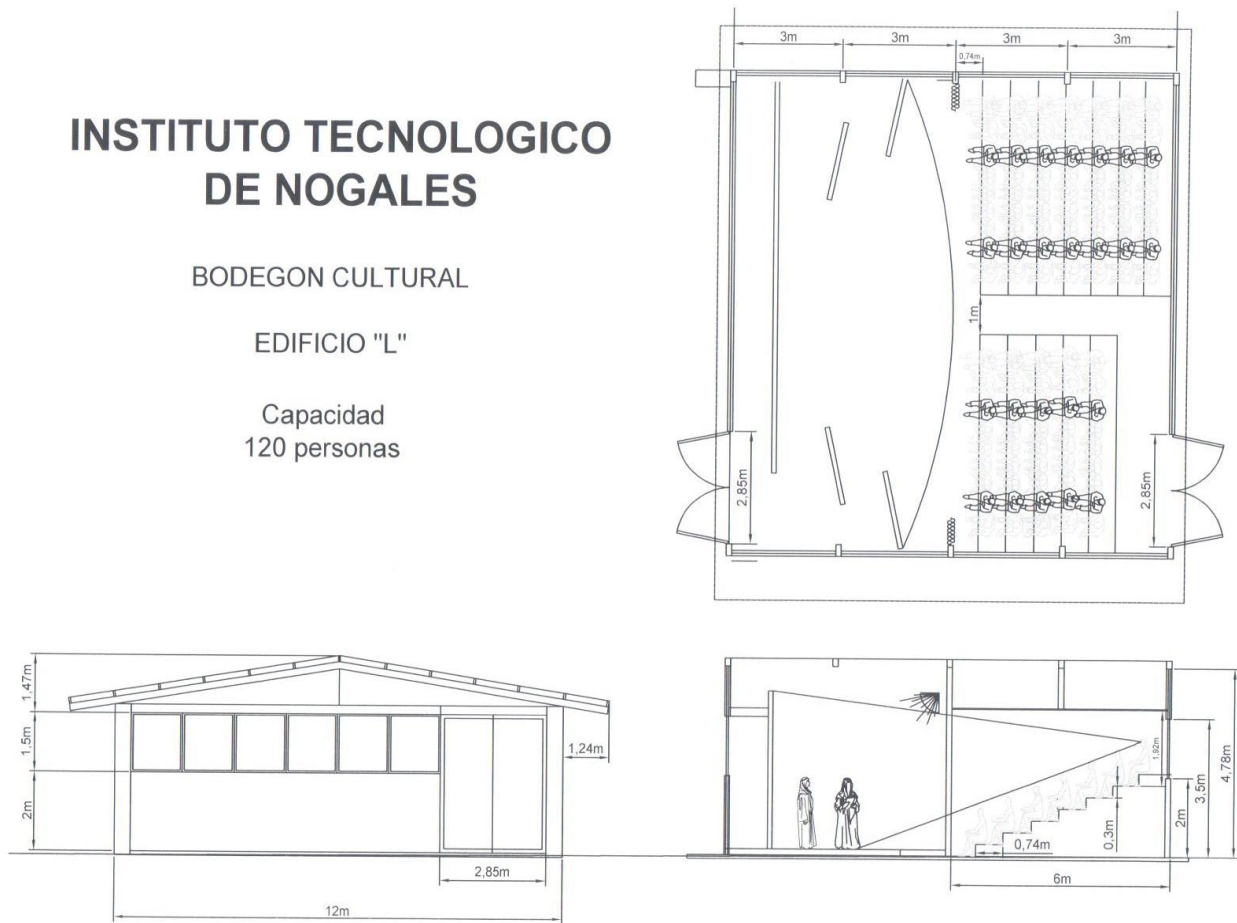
Plano Arquitectónico del Bodegón Cultural ITN II
